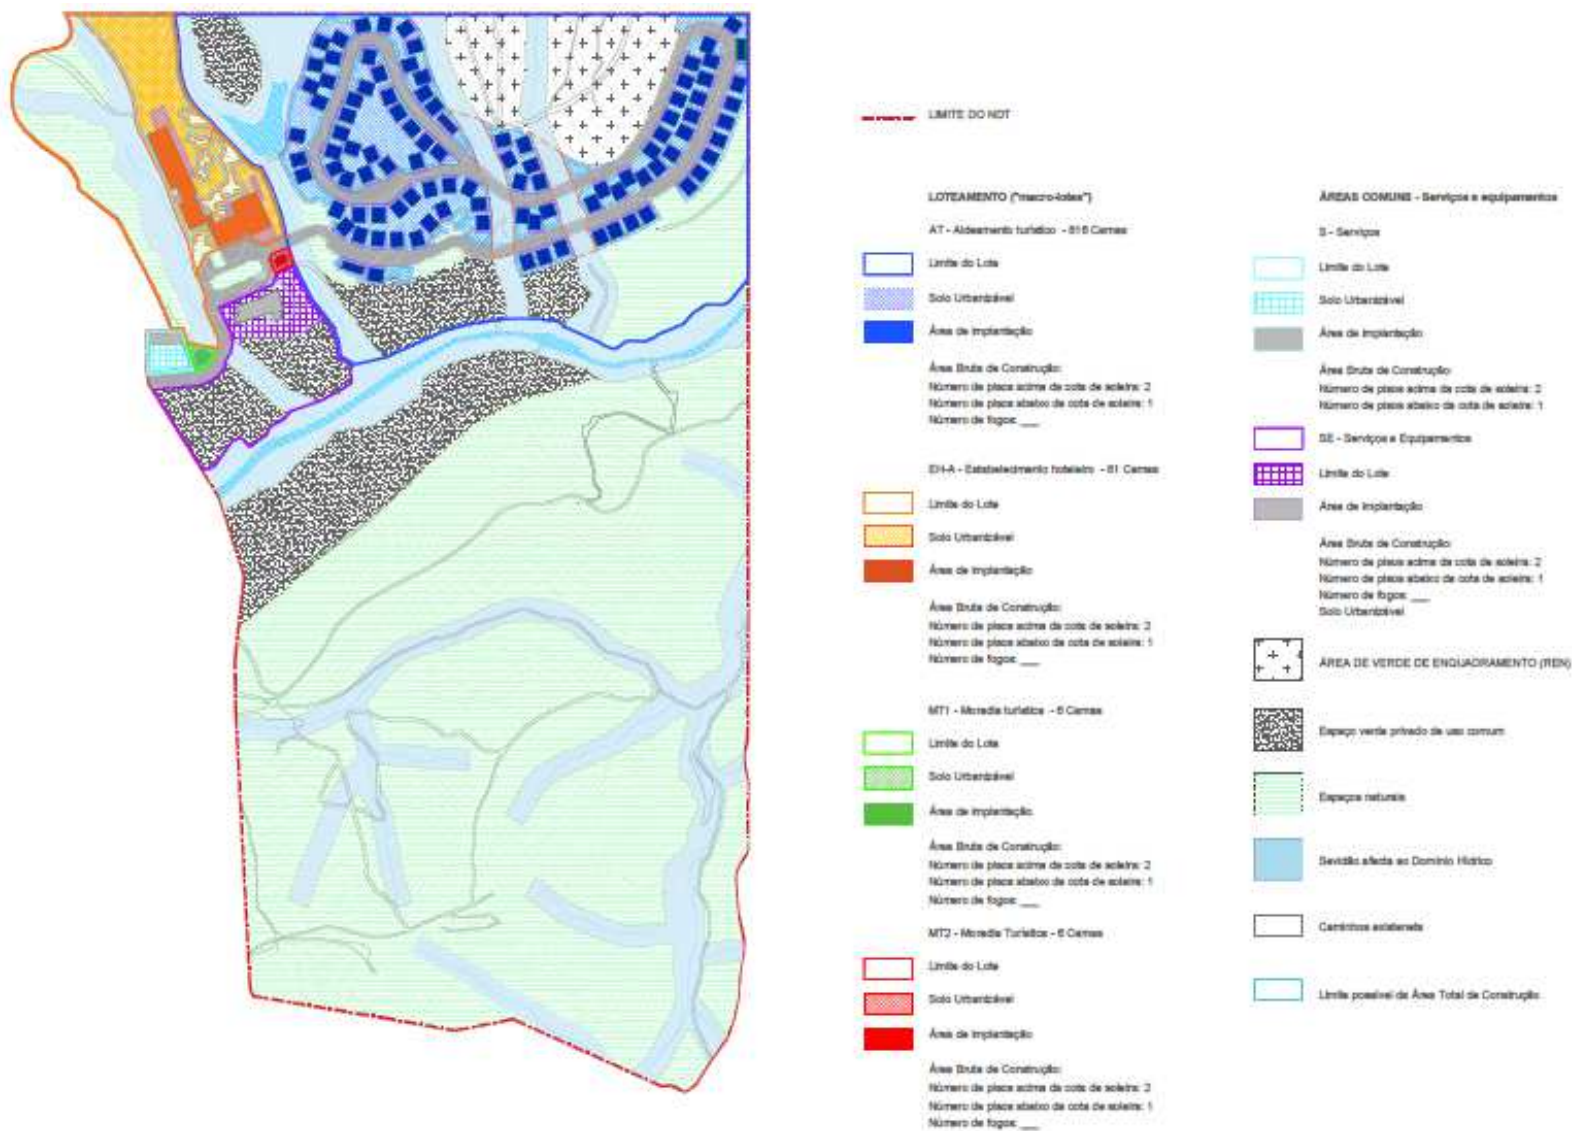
Planta síntese - Planta de implantação com REN e RAN. Anexo VII
